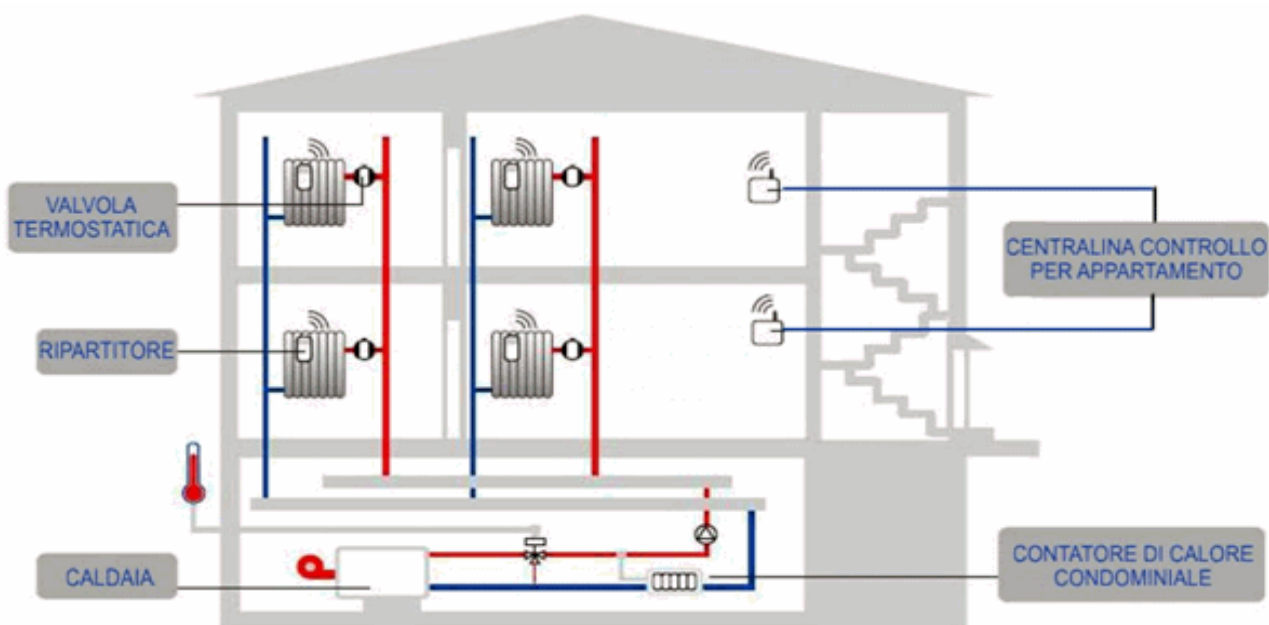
Schema di contabilizzazione del calore in un impianto di distribuzione
